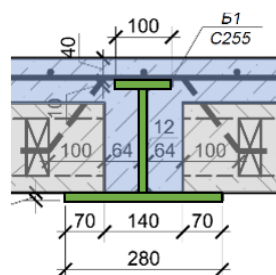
Схема и модели группы 3 (М3.1) со сварной балкой:
